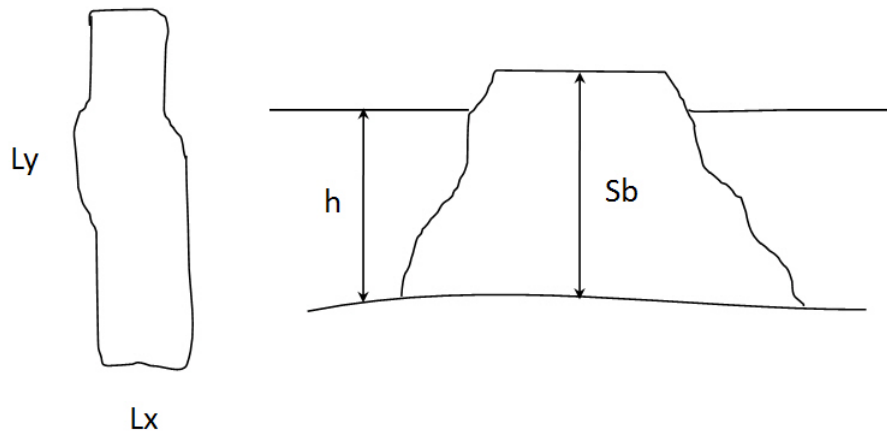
Dimensiones genéricas de una obra marítima en planta (izquierda) y en alzado (derecha).
